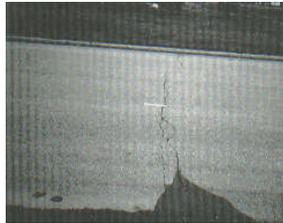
b. Grietas longitudinales y transversales (No PCC) de severidad media.
